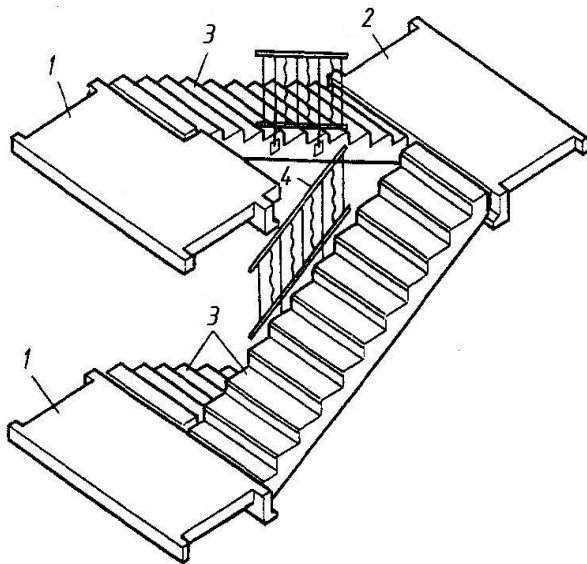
Збірні сходи з великорозмірних елементів: 1 – поверхові сходові площадки, 2 – проміжні сходові площадки, 3 – сходовий марш, 4 – фрагмент огородження
